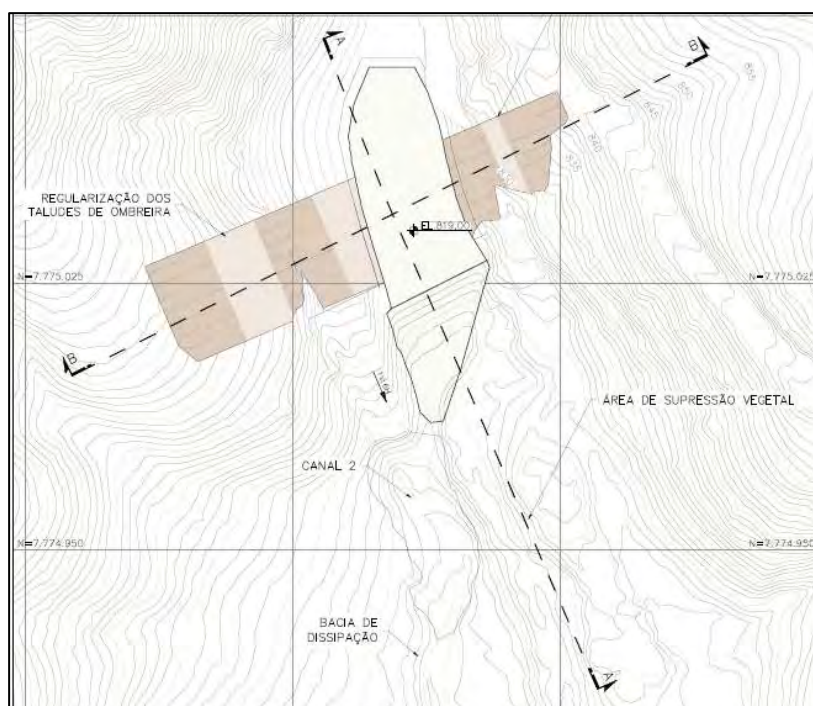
Planta de locação da Seção A-A e B-B para análises de estabilidade.
